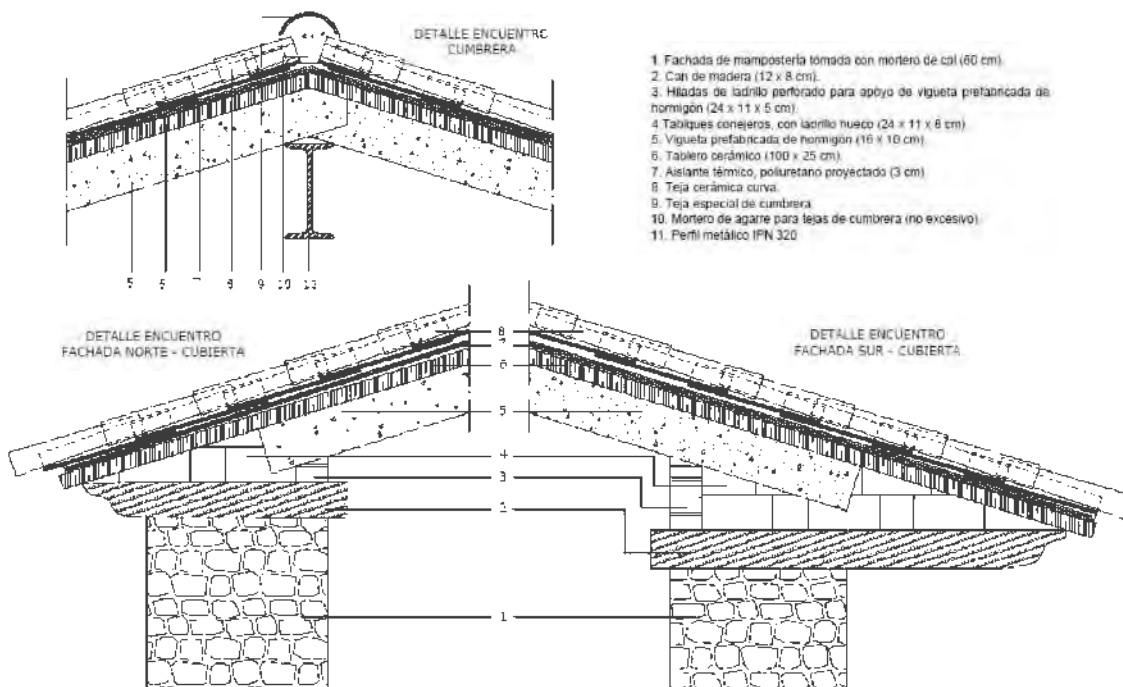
Detalles constructivos cubierta. Fuente: propia.
